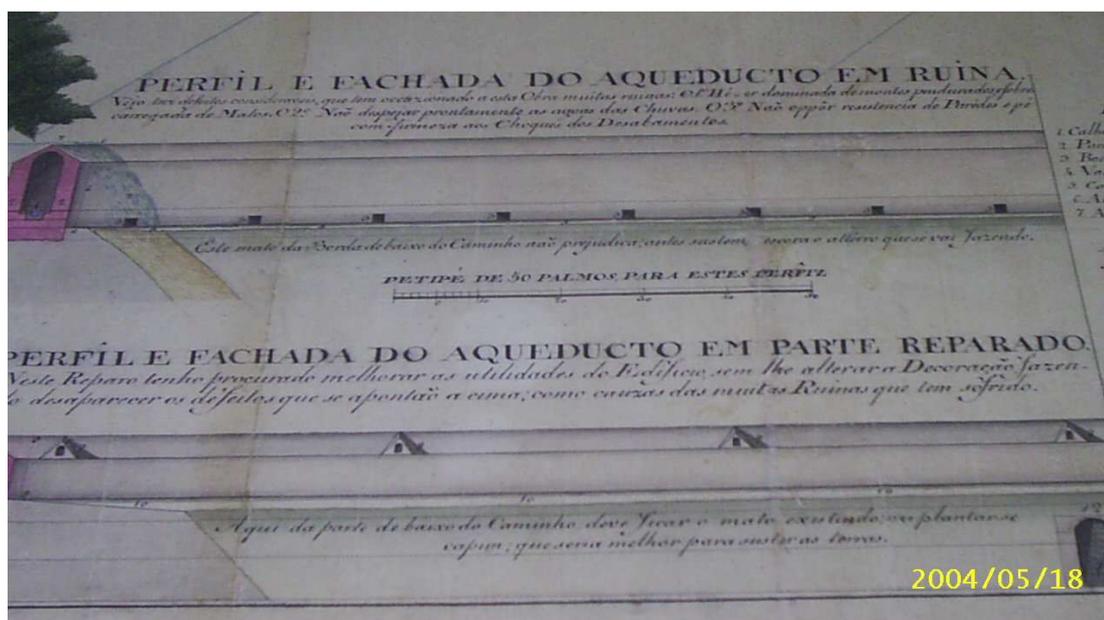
Planta do Aqueduto da Carioca, 1814 - Arquivo do Exército.
